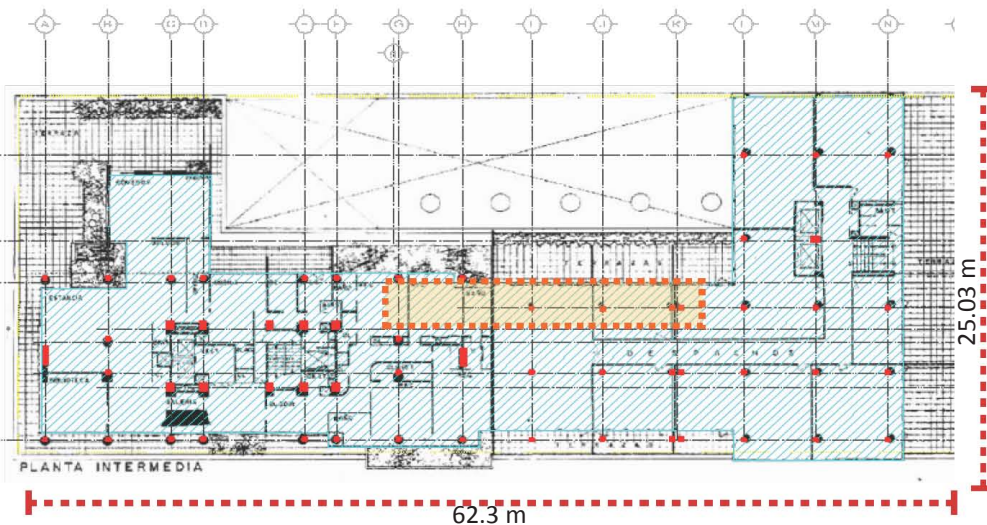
Plano de Planta Intermedia. Modificado para fines académicos. En éste plano se marca con rojo la estructura y en sombreado cian las áreas ocupadas Fuente: creación propia
